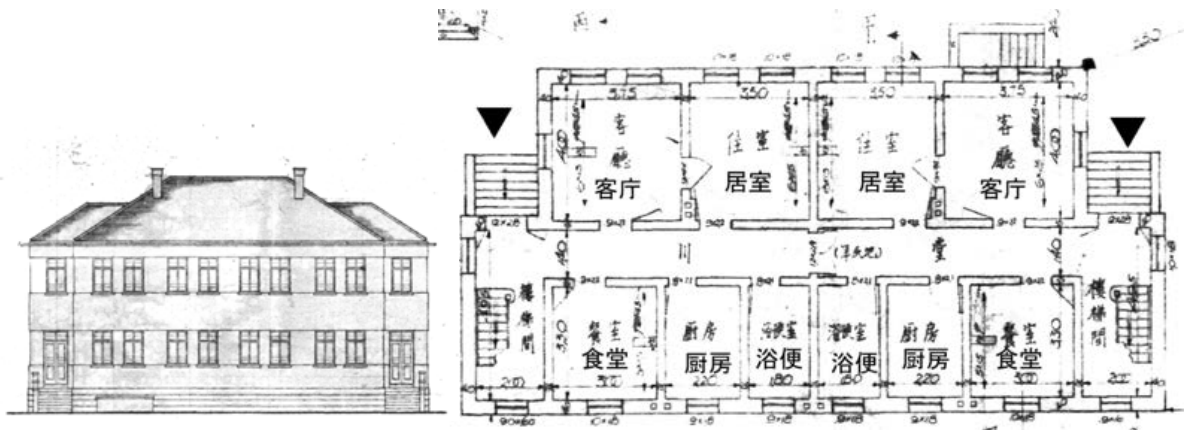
㉔の立面図と一階平面図(档案「1941-0212」より)
